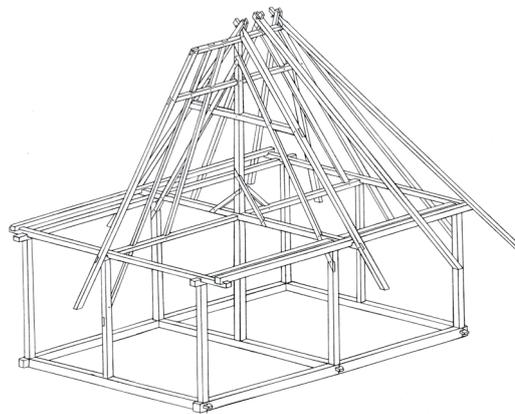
Hochfirstständergerüst mit einem zentralen Hochfirstständer. Gontenschwil (Kt. Aargau), 1608 (d). Rekonstruktion nach Räber 2002, ohne Maßstab.
